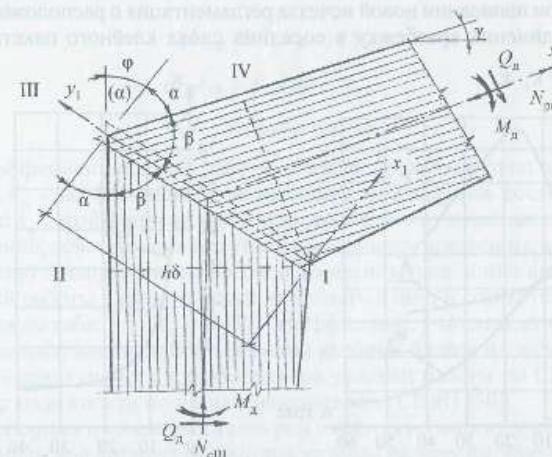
Расчетная схема узла с соединением ригеля и стойки на зубчатый шип под углом
